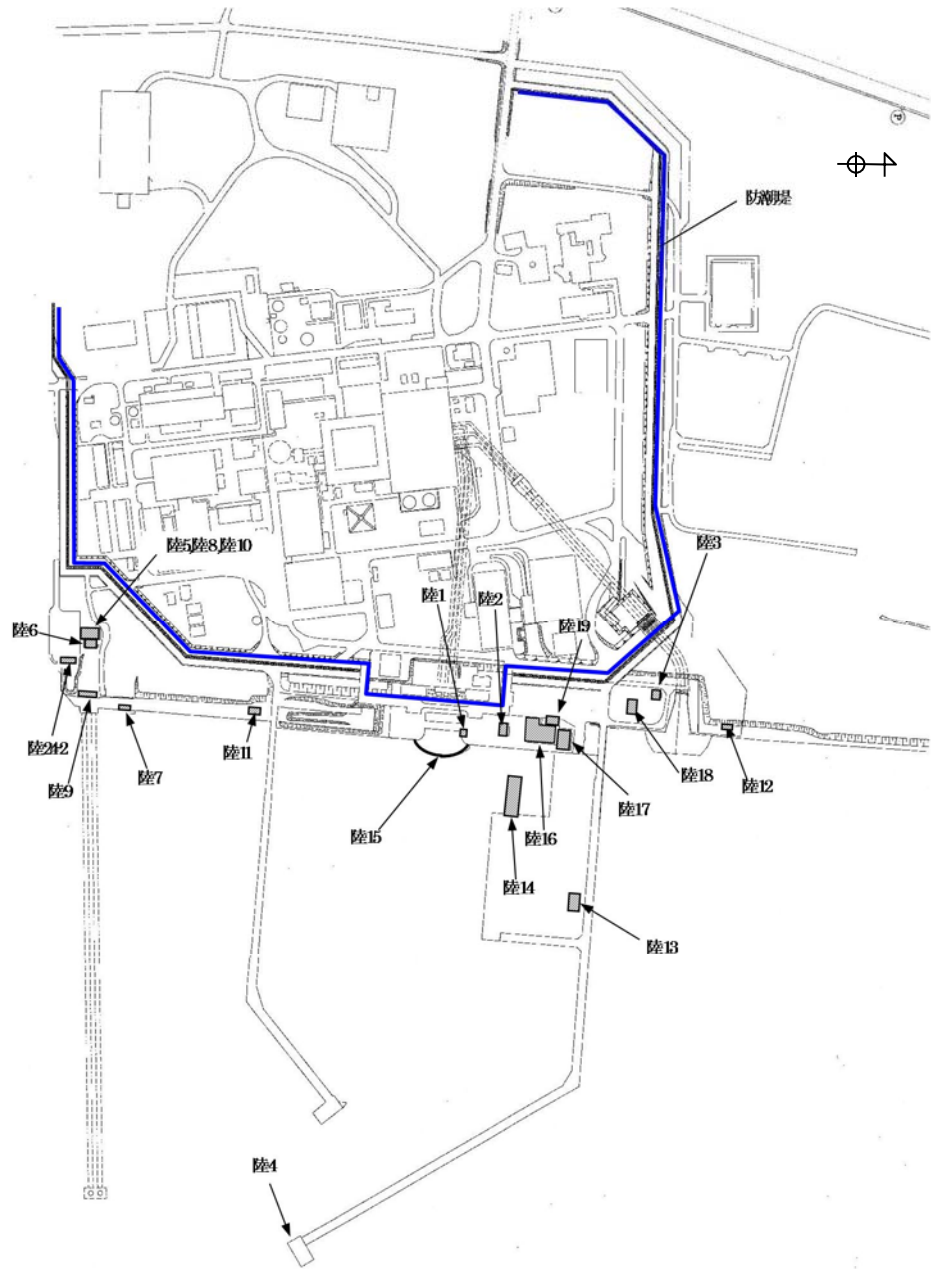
防潮堤東側エリアに設置されている構築物位置図
